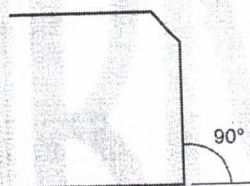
Detalhe do ângulo de inclinação da peça de concreto
